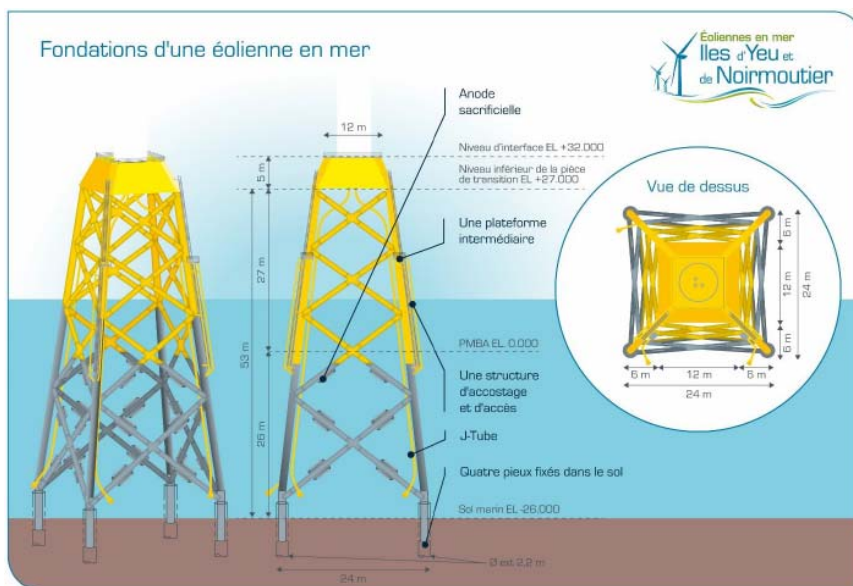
Fondation des éoliennes sur jacket. source : dossier
